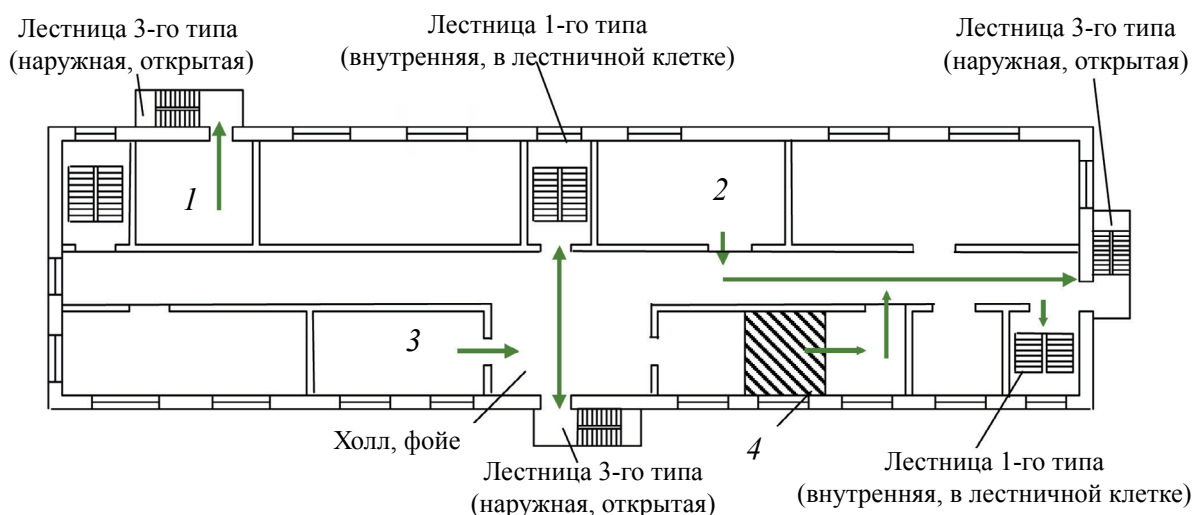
Эвакуационные выходы из помещений, расположенных на любых этажах, кроме первого. Описание маршрута эвакуации из помещений любого этажа, кроме первого:
